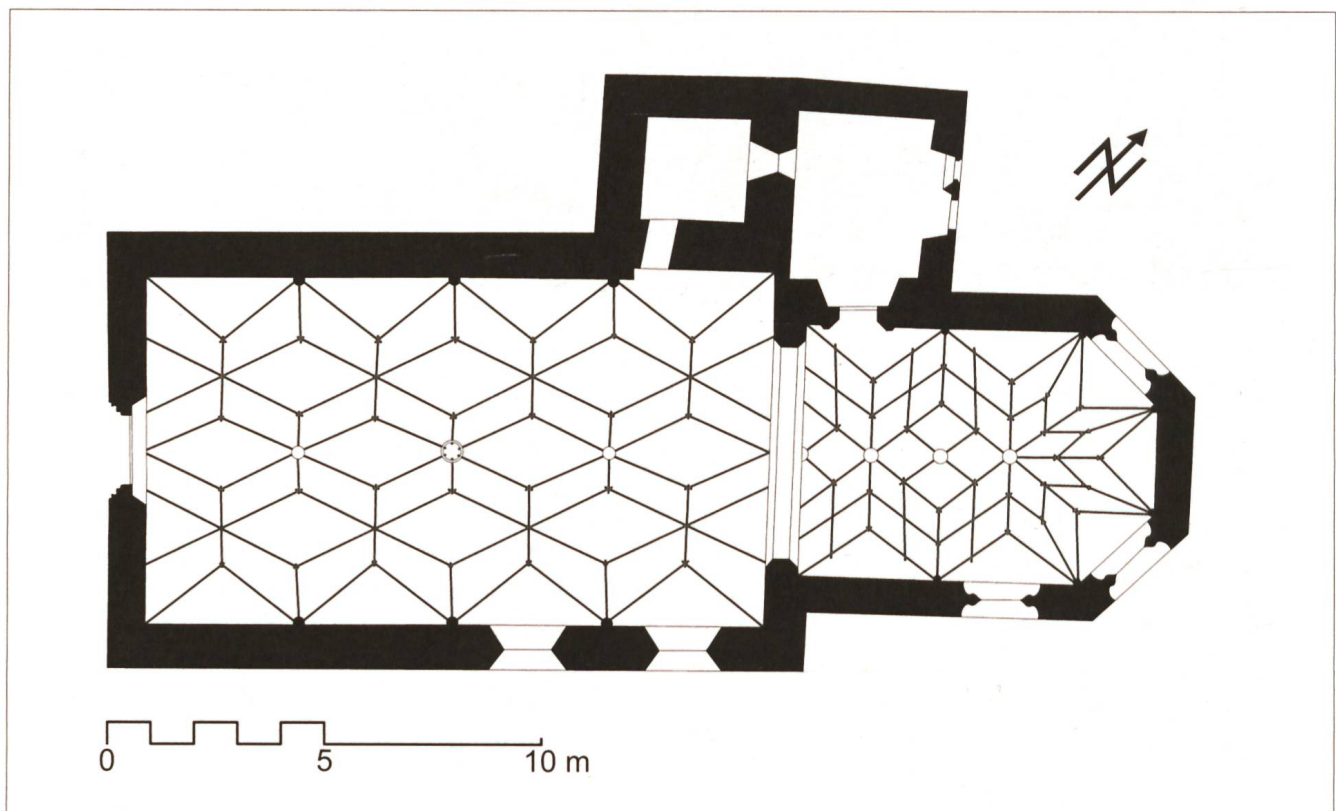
Grundriss der Pfarrkirche von Stierva aus Laserscans und tachymetrischen Messungen erstellt.
